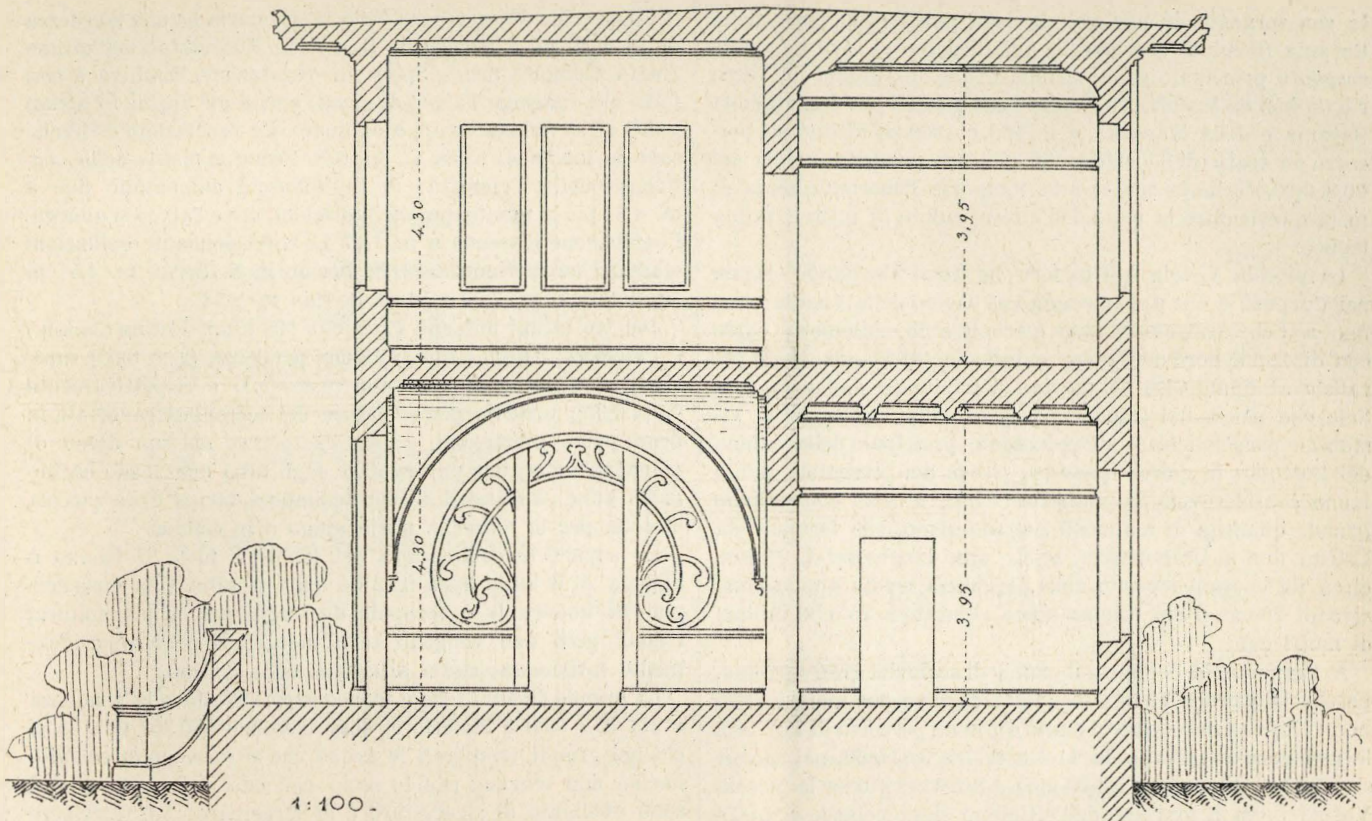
Sezione trasversale della Palazzina Lauro.
